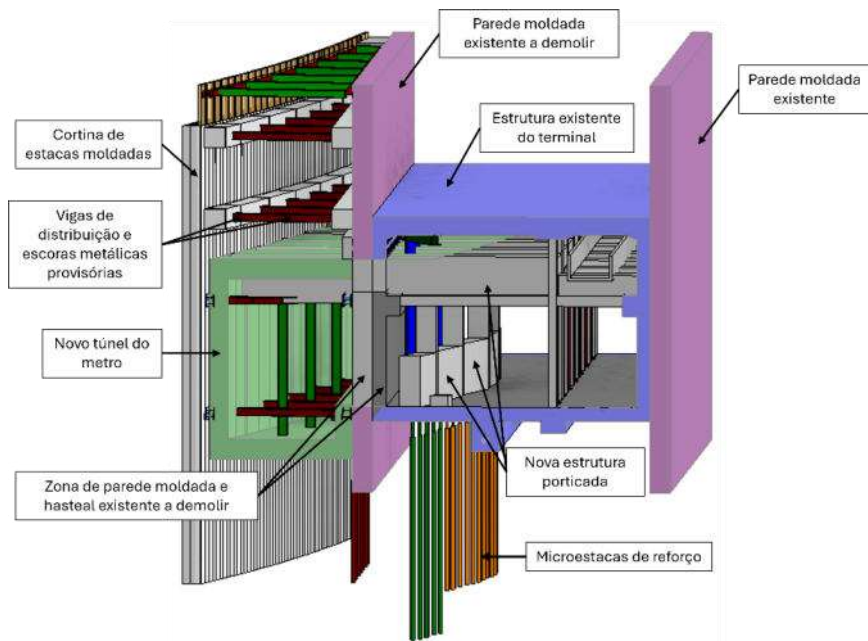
Vista 3D da Escavação em Cut & Cover e da Estrutura Definitiva do Terminal
